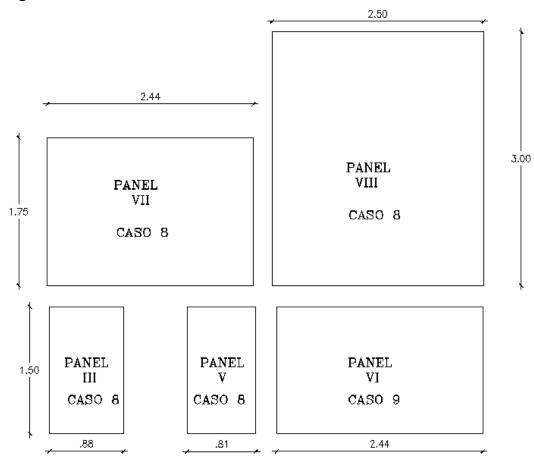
Paneles de losa maciza en dos direcciones N+2.52
